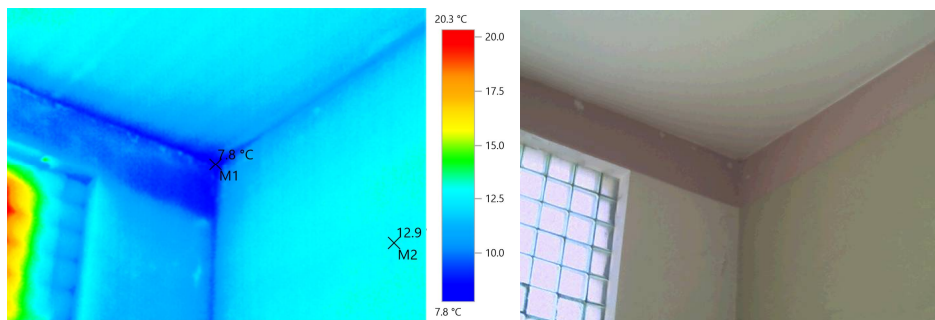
Сопряжение плит покрытия и наружных стен со следами плесени
